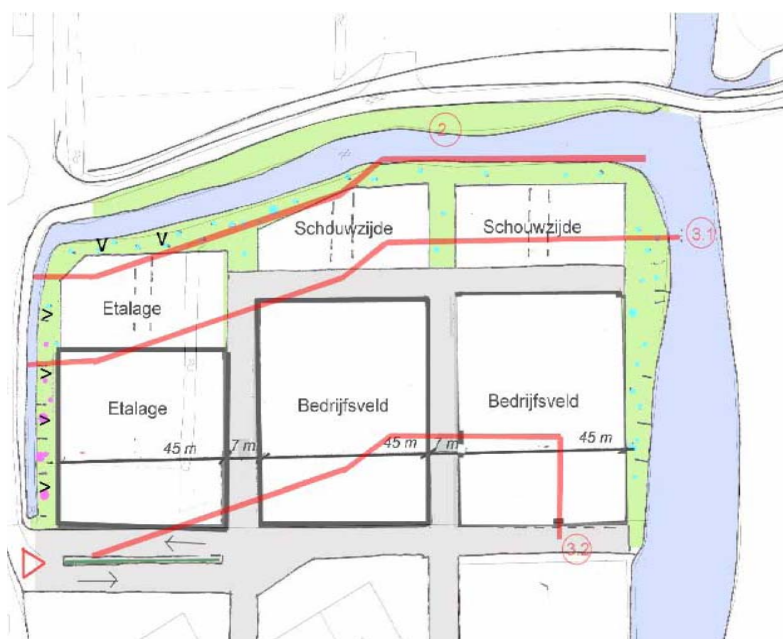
Variant 1 bebouwing na planontwikkeling
